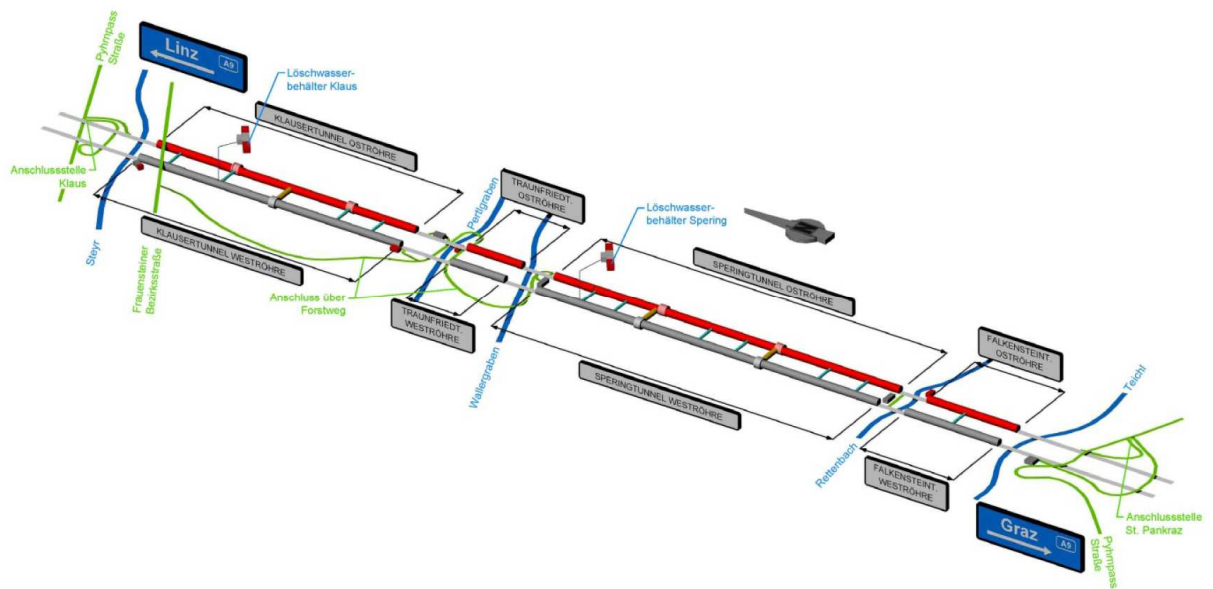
Schematische Darstellung Tunnelkette Klaus im Vollausbau
